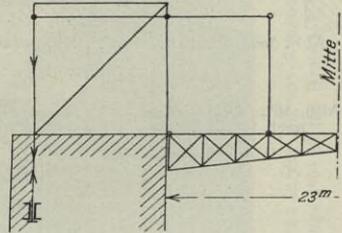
b. Doppelte Portalbrücke im Anschluß an eine feste Brücke.
